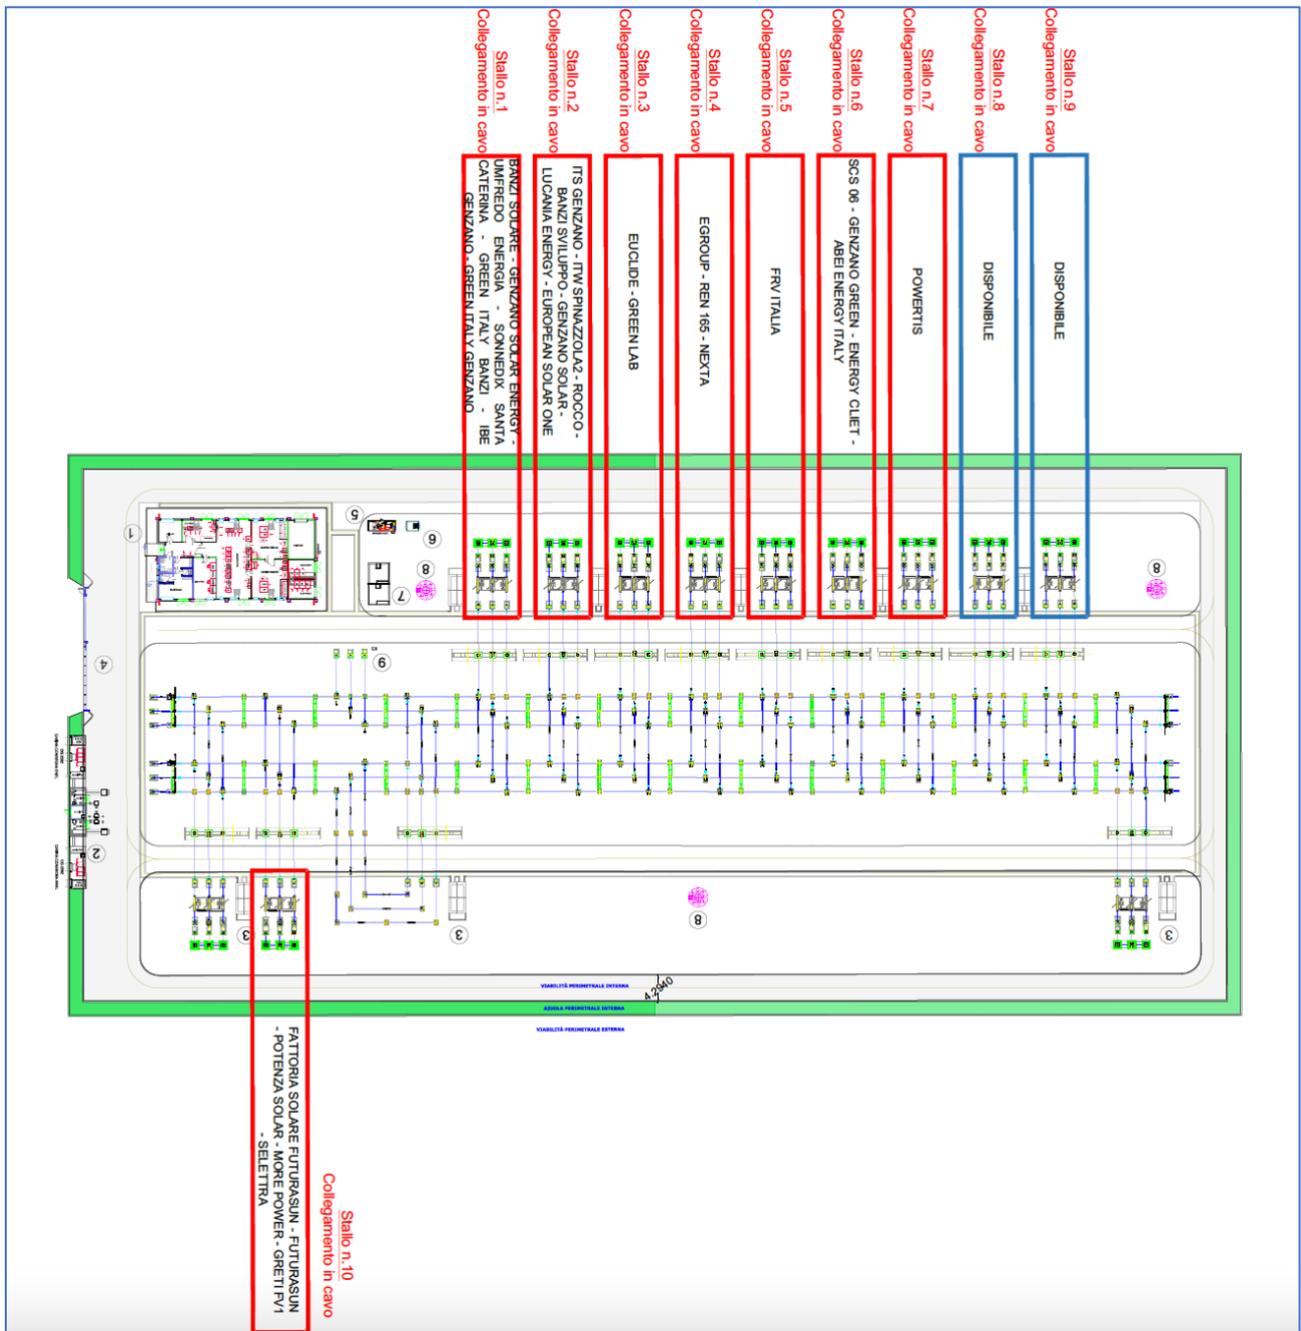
Planimetria elettromeccanica della Stazione “satellite” Terna Genzano con individuazione dell’assegnazione stalli (stallo n.7 dedicato a POWERTIS)
